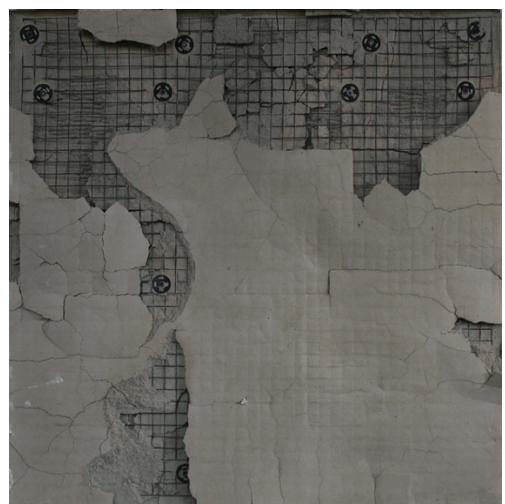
耐火試験後の状況 (No. 5) [P3]
